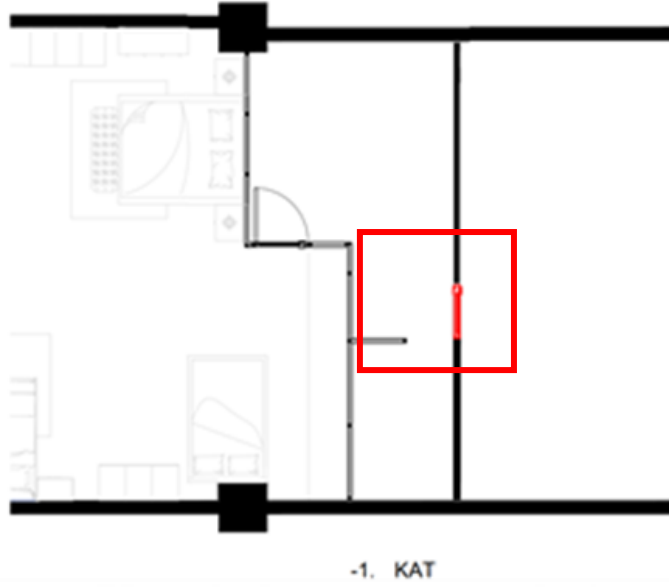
Vivense Beylikdüzü mağazası -1. kat tavan planı
